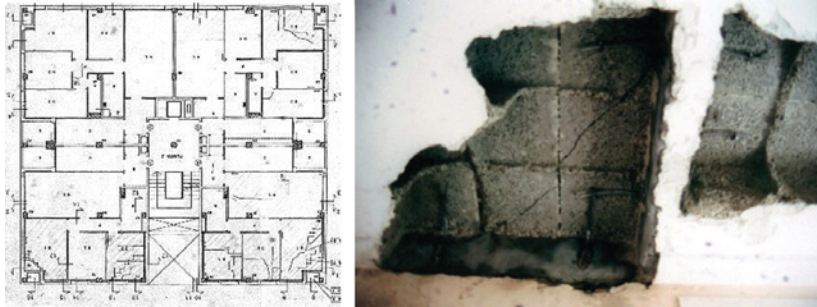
Planta de un forjado reticular con un esquema de fisuración por las tensiones de "cortante-flexión". En la foto, detalle de la rotura en diagonal del casetón que recubre la chapa de compresión entre los nervios, en la zona anexa al macizado del capitel.
